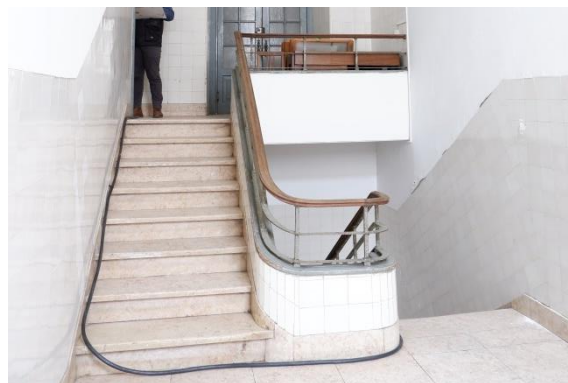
Exemplos de elementos em betão armado que constituem a estrutura do corpo 7
